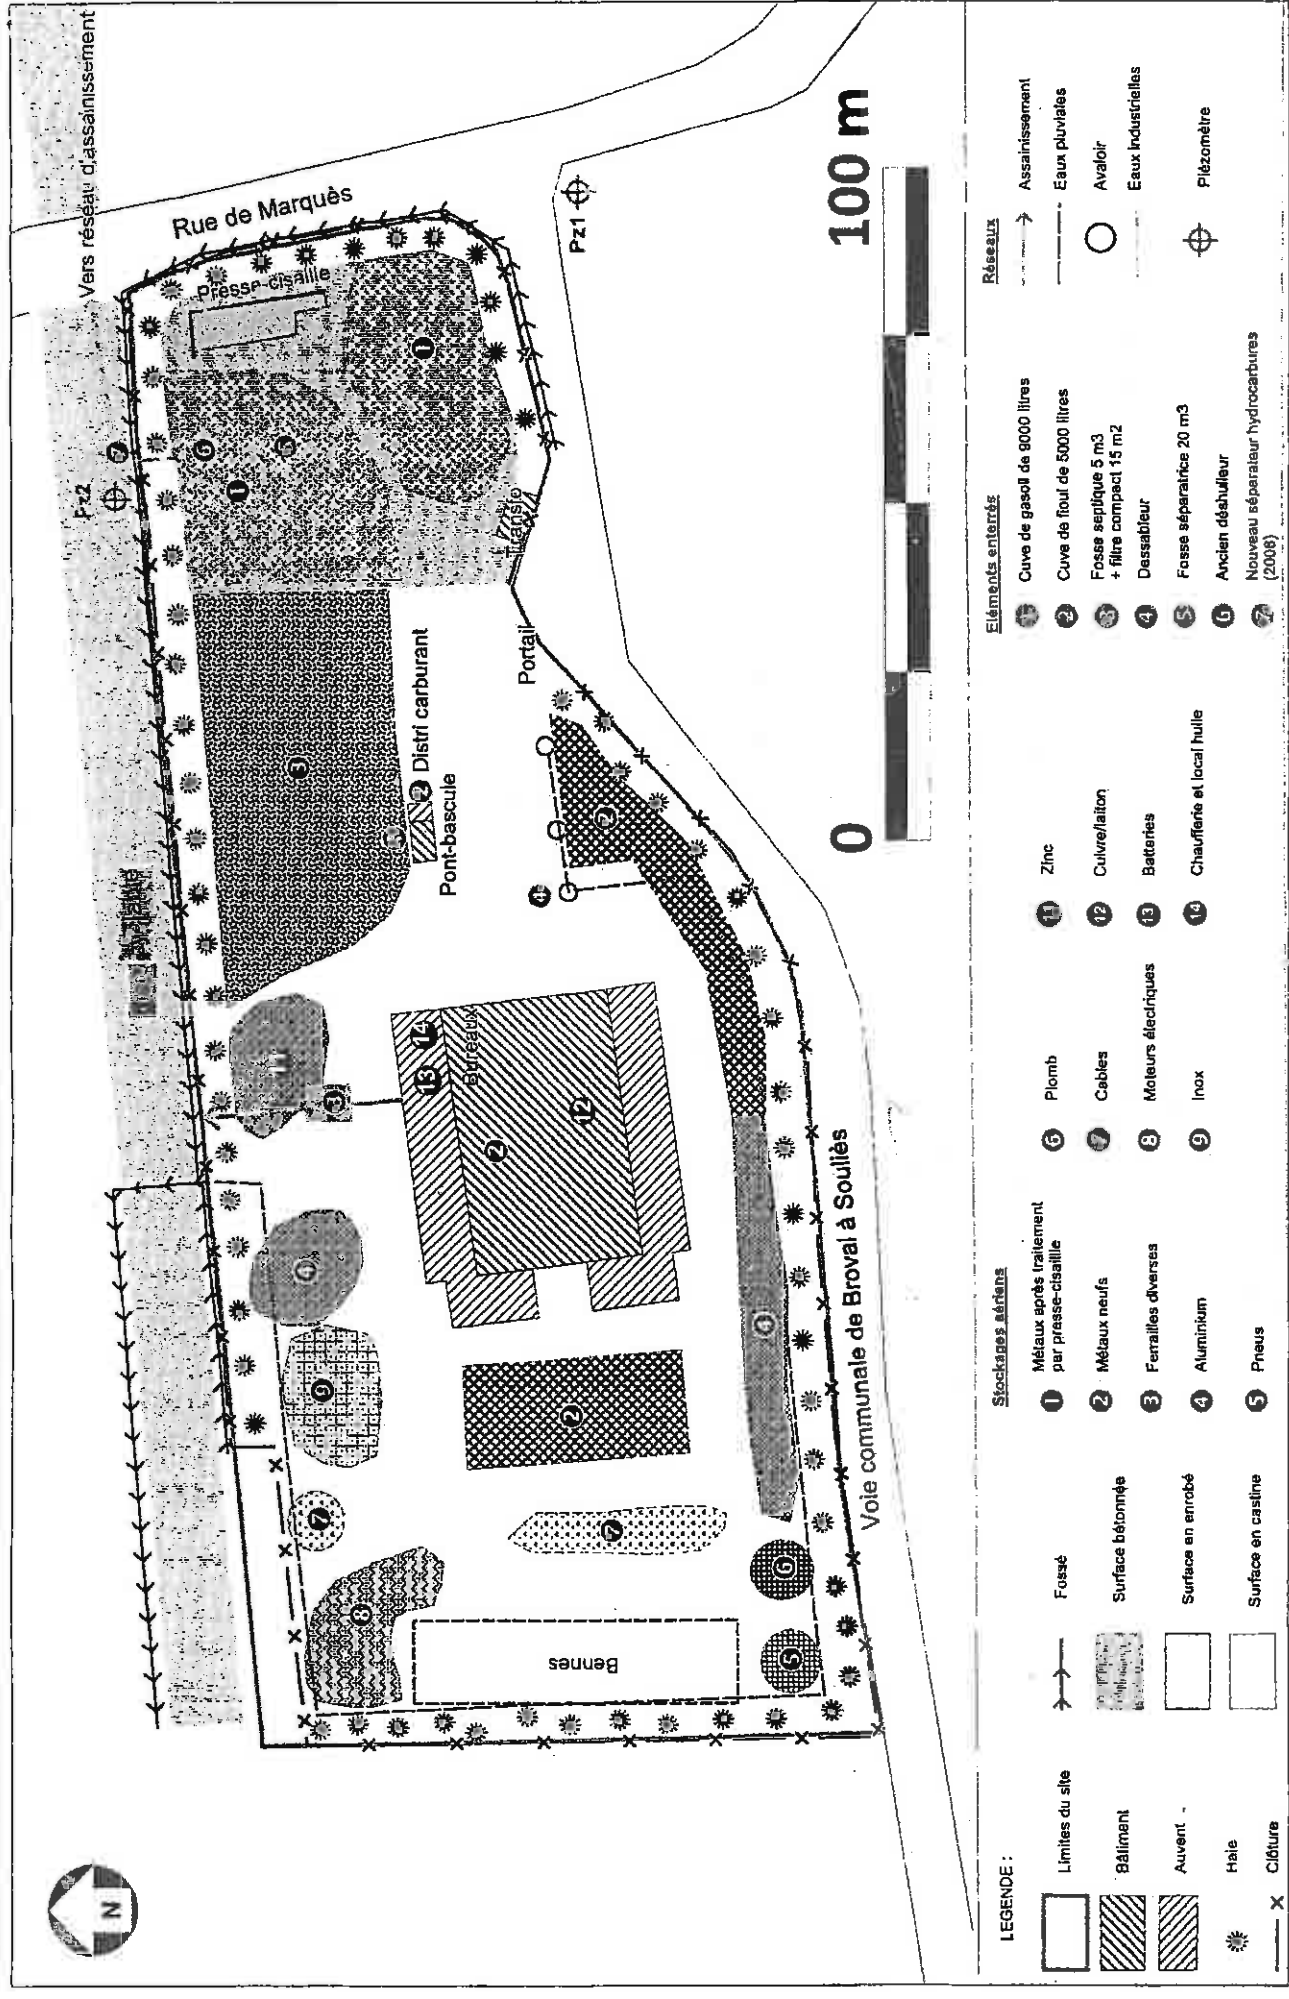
Plan de masse du site lors de son fonctionnement (en 2009)
